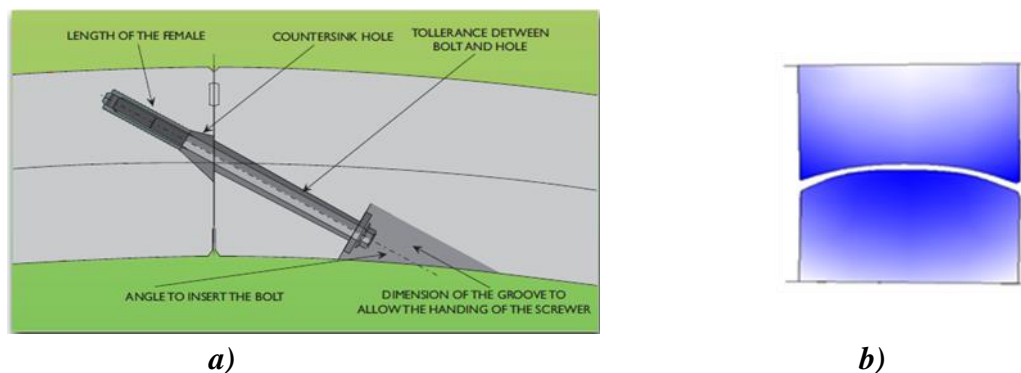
Junta entre dovelas: a) esquema de una junta plana (Vittorio et al., 2009); b) junta convexa
